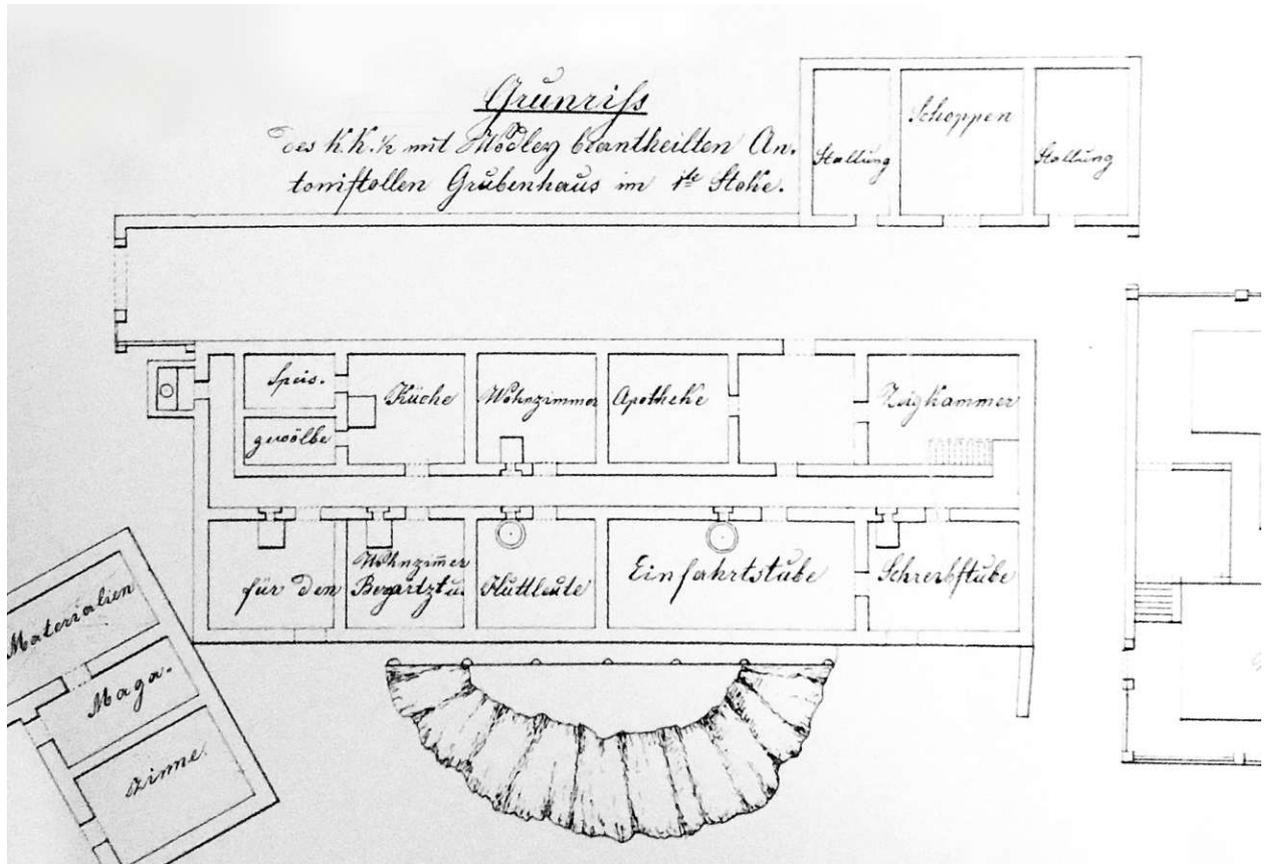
Grundriss des Antoni Grubenhaus aus Mitte des 19. Jahrhunderts
